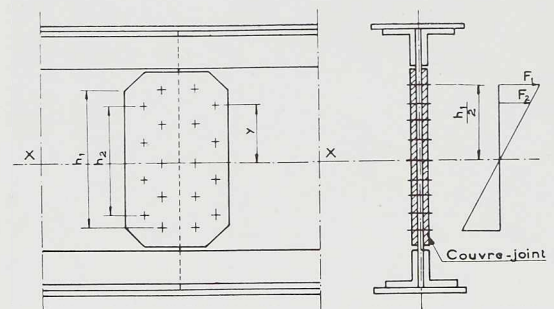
Poutre soumise à flexion assemblée par couvre-joints.
